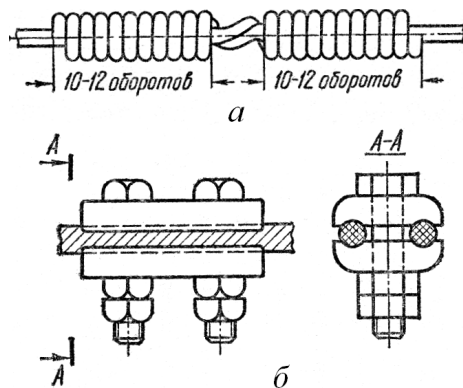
Соединение проводов воздушной линии электропередачи: а — скруткой; б — соединительный плашечный зажим
